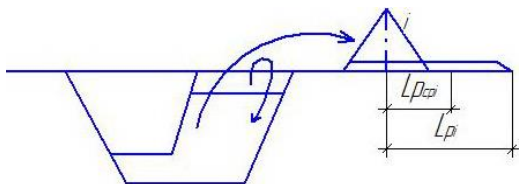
Схема укладки грунта в отвал и разравнивания при доработке
